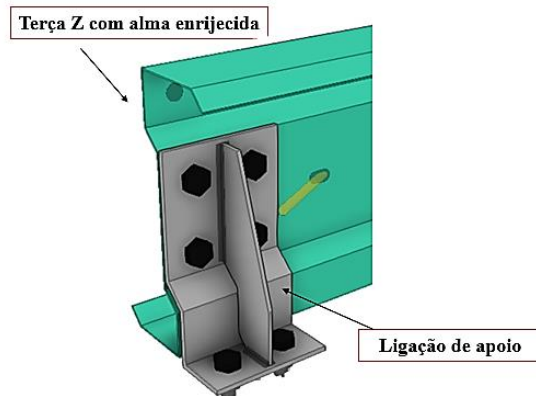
Detalhe da ligação de apoio. Fonte: os autores.
